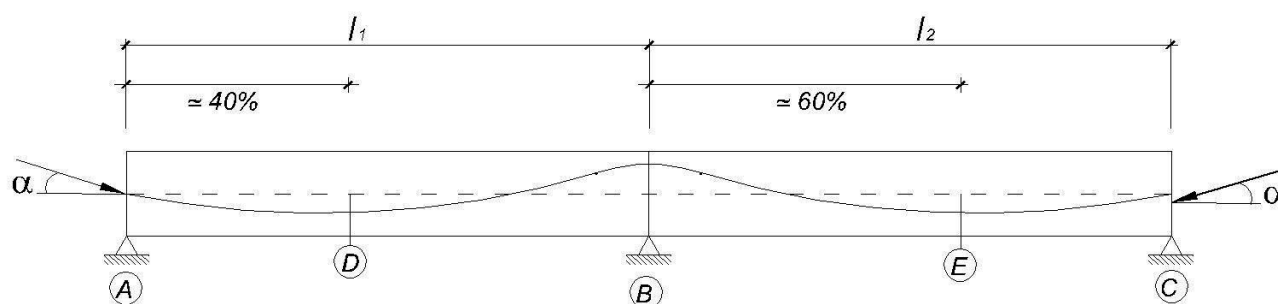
Traçado suavizado do cabo de pré-esforço 1.
